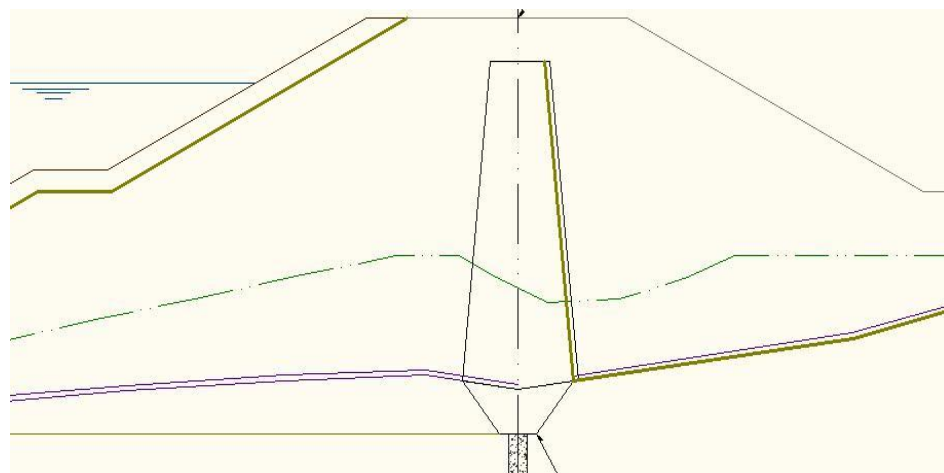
Ubicación de Geotextil utilizado en la Sección Típica de Presa
